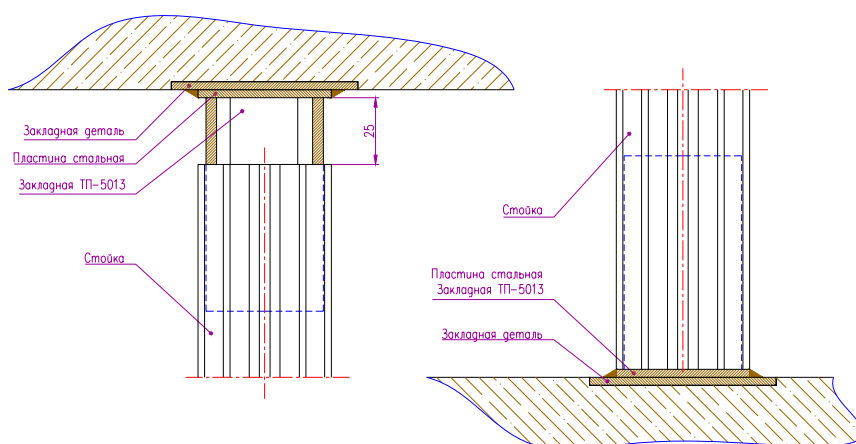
Верхний и нижний монтажный узел стойки ТП-50311
